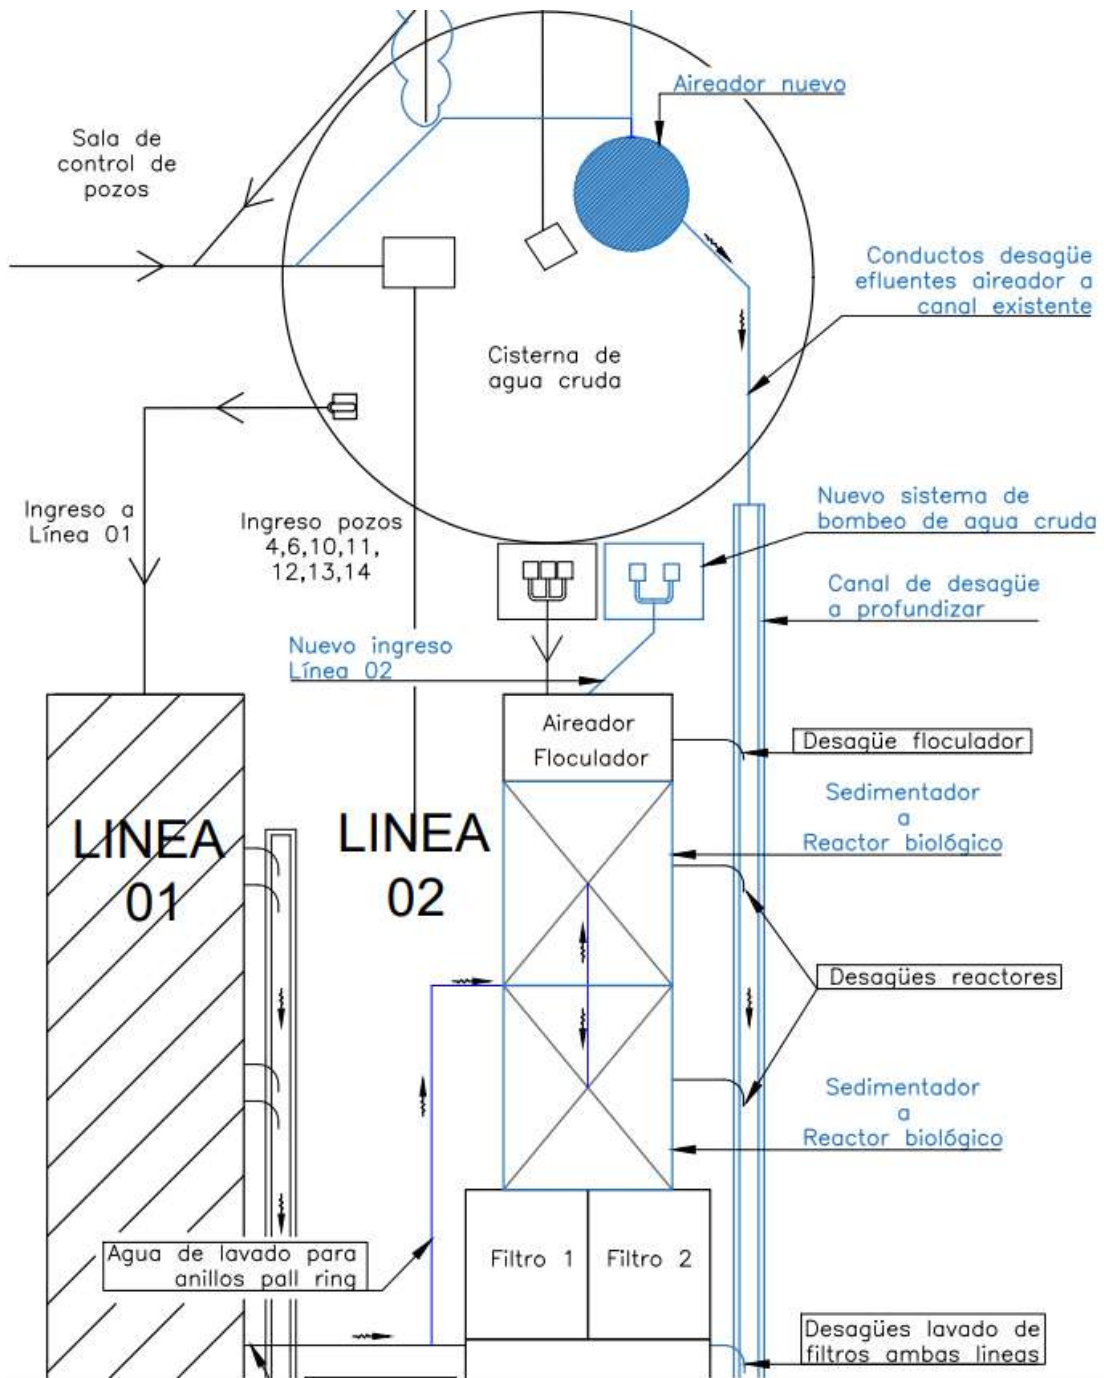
Vista en planta de las unidades de potabilización – Fuente de elaboración propia
